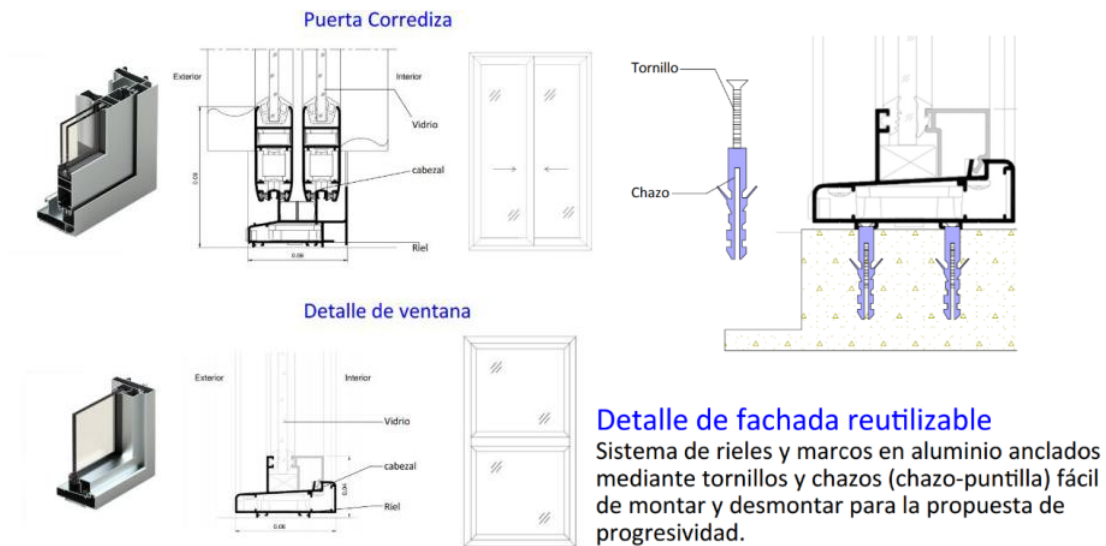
detalles de anclaje de fachada, Fuente: Elaboración Propia.
